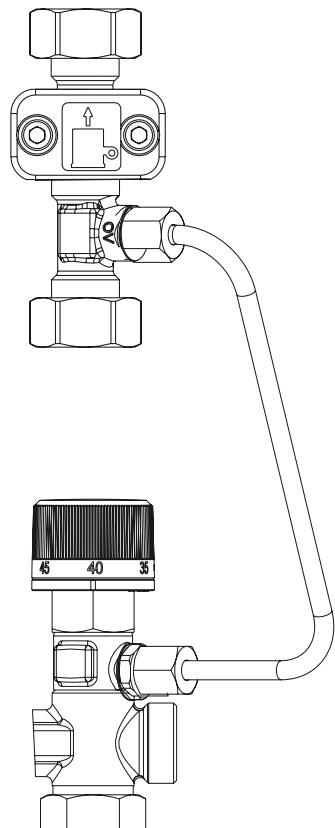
Montage du tube en cuivre Regudis W-HTO Duo
